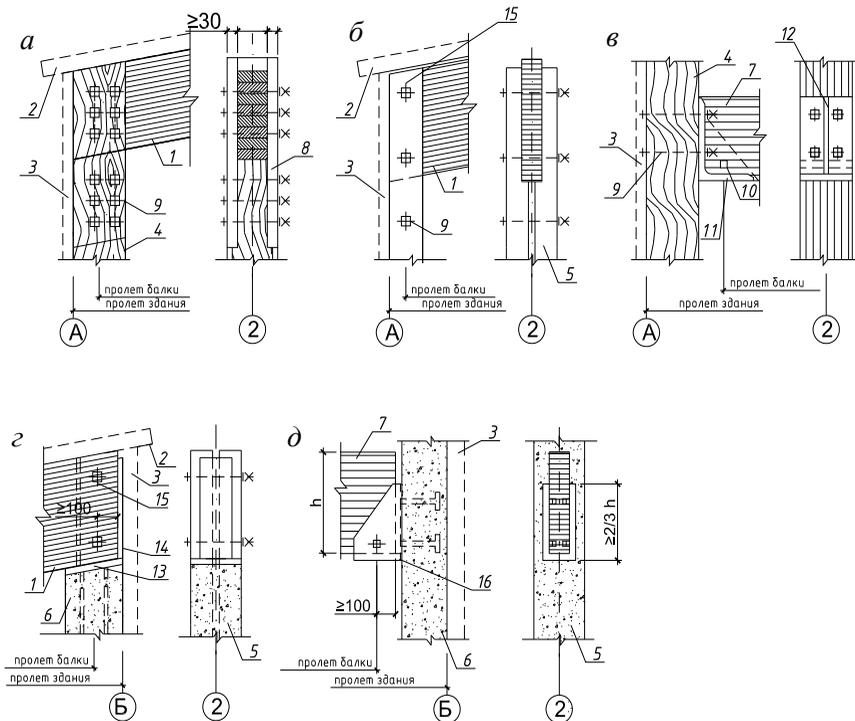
Опирание клеодощатых балок в каркасных зданиях:
